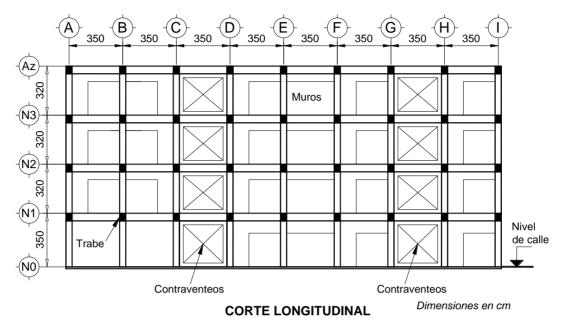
Ejemplo de croquis de elevación de una estructura
